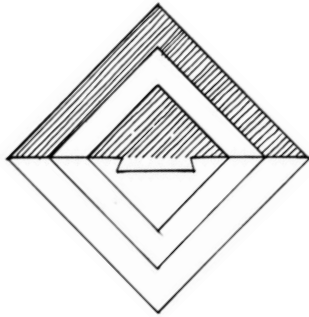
Zona de compressió paral·lela a la fibra al cas 1 (Elaboració pròpia)
